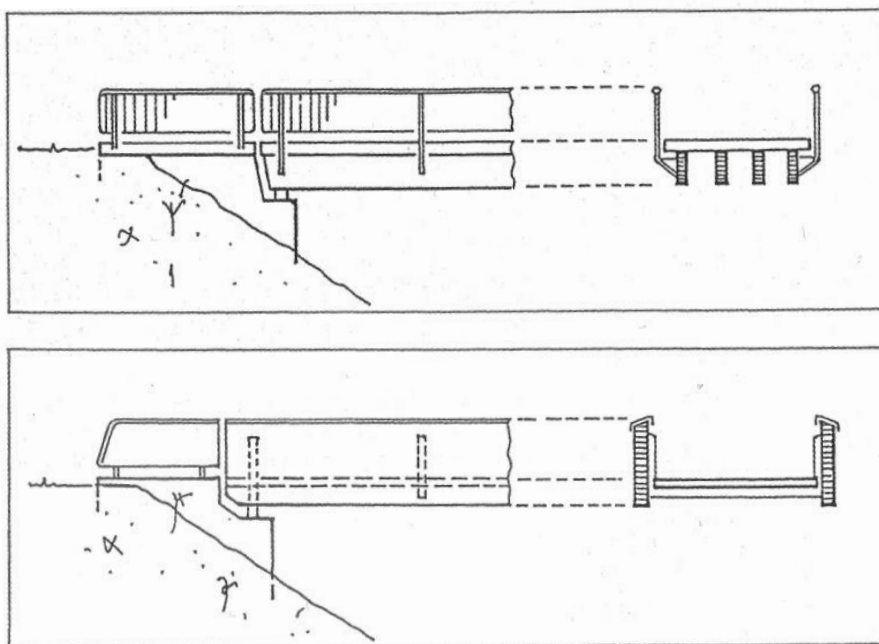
Colocación de la estructura principal en pasarelas de viga simple
